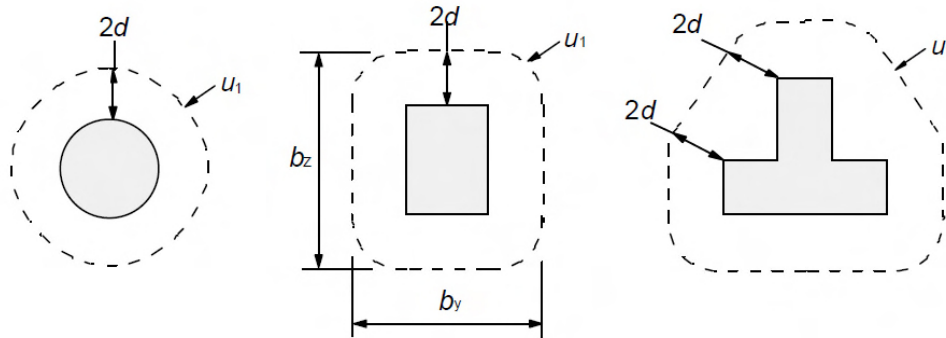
Tipos de perímetros críticos alrededor de las zonas cargadas
